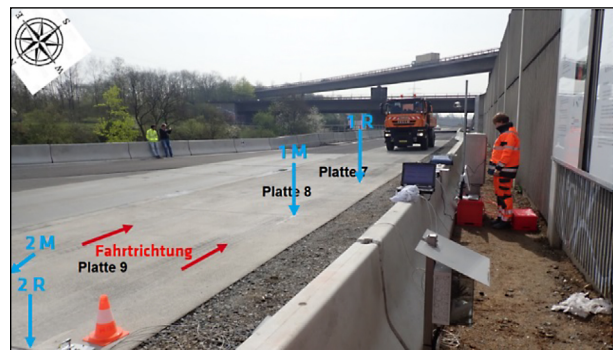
Einbaulage der Sensorensysteme auf der Waschbetonstrecke 40, Blick nach Süden
